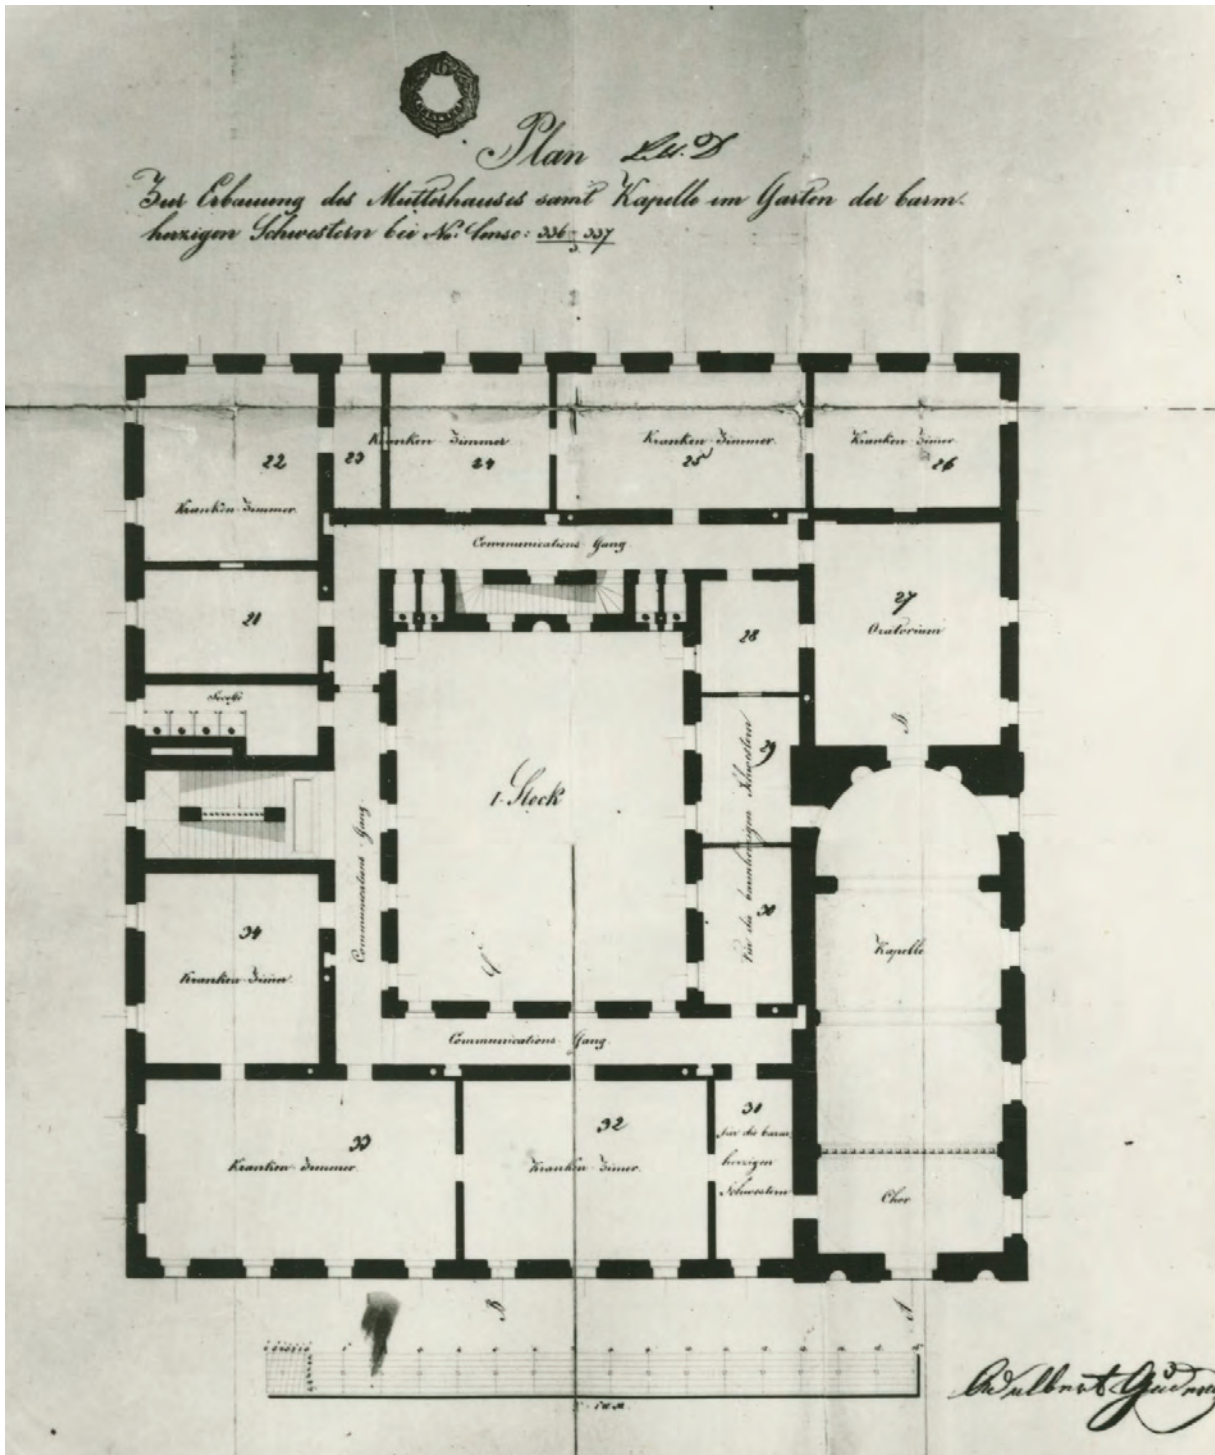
Plan zur Erbauung des Mutterhauses samt Kapelle im Garten der Barmherzigen Schwestern bei Nr. 336 und 337, Grundriss, 1. Obergeschoss, Architekt Adalbert Gudera, 1851
